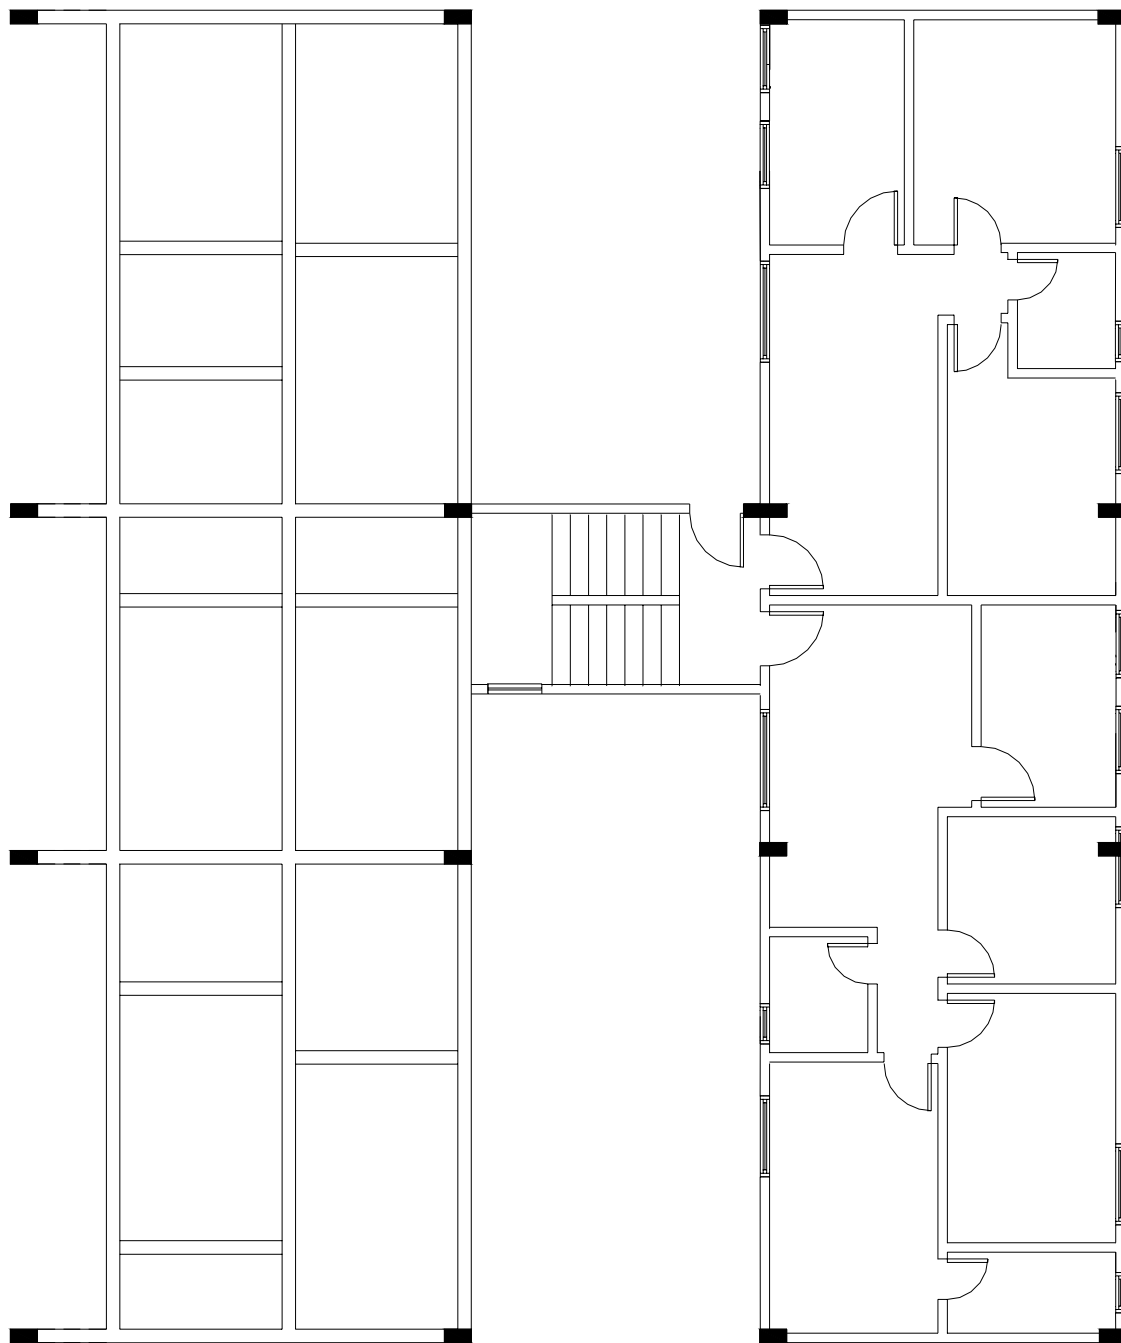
Residencial “J” – Bloco 5 – Segunda solução de vigamento de pilotis
